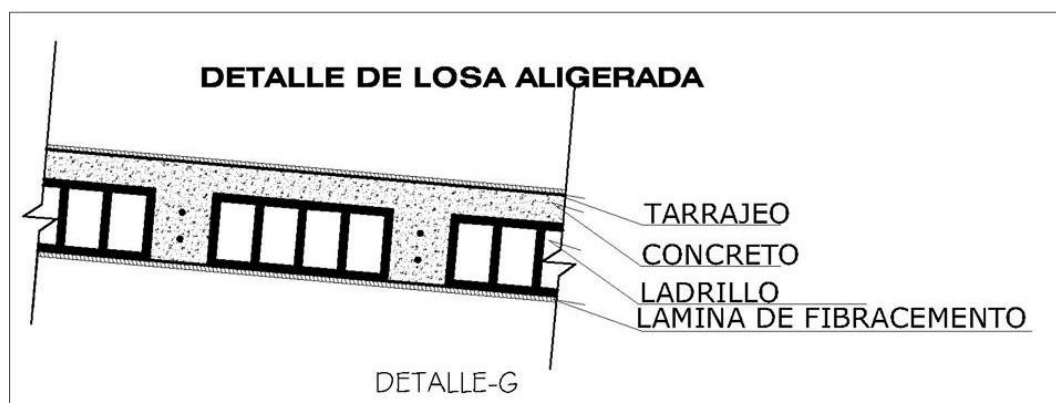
detalle del aislamiento de cubiertas inclinadas en aulas académicas.
